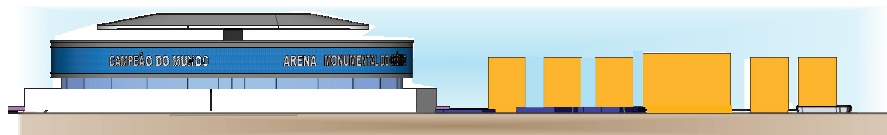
Maquete eletrônica | Corte Esquemático Av. Padre Leopoldo Bretano
